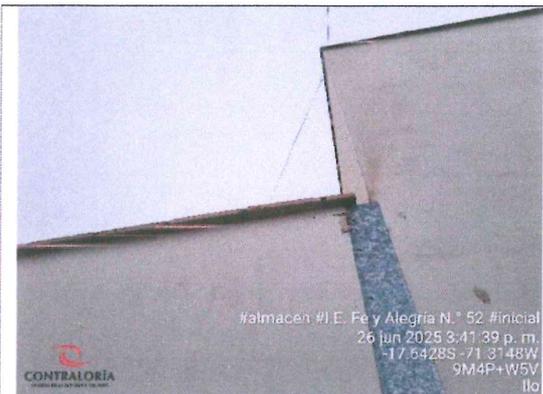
Fisura en enlucido adyacente a pastelero.
